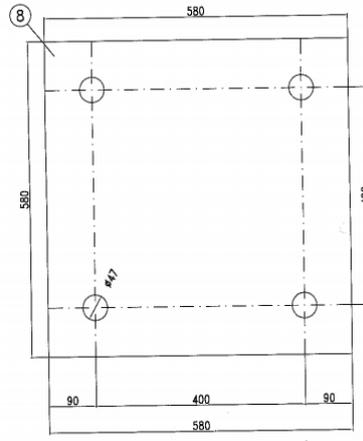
Piastra e disposizione tirafondi LSU18a
